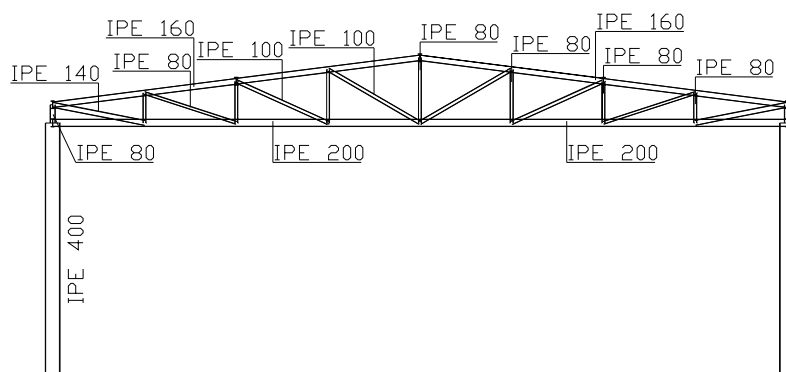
Pórtico com pilar de alma cheia, viga em treliça, vão de 20.00m, pilar e viga em perfil com secção transversal IPE.
